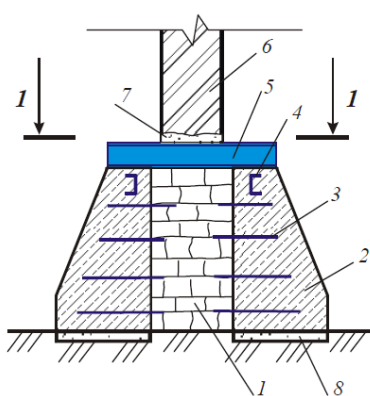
Усиление фундаментов монолитными бетонными банкетами:
